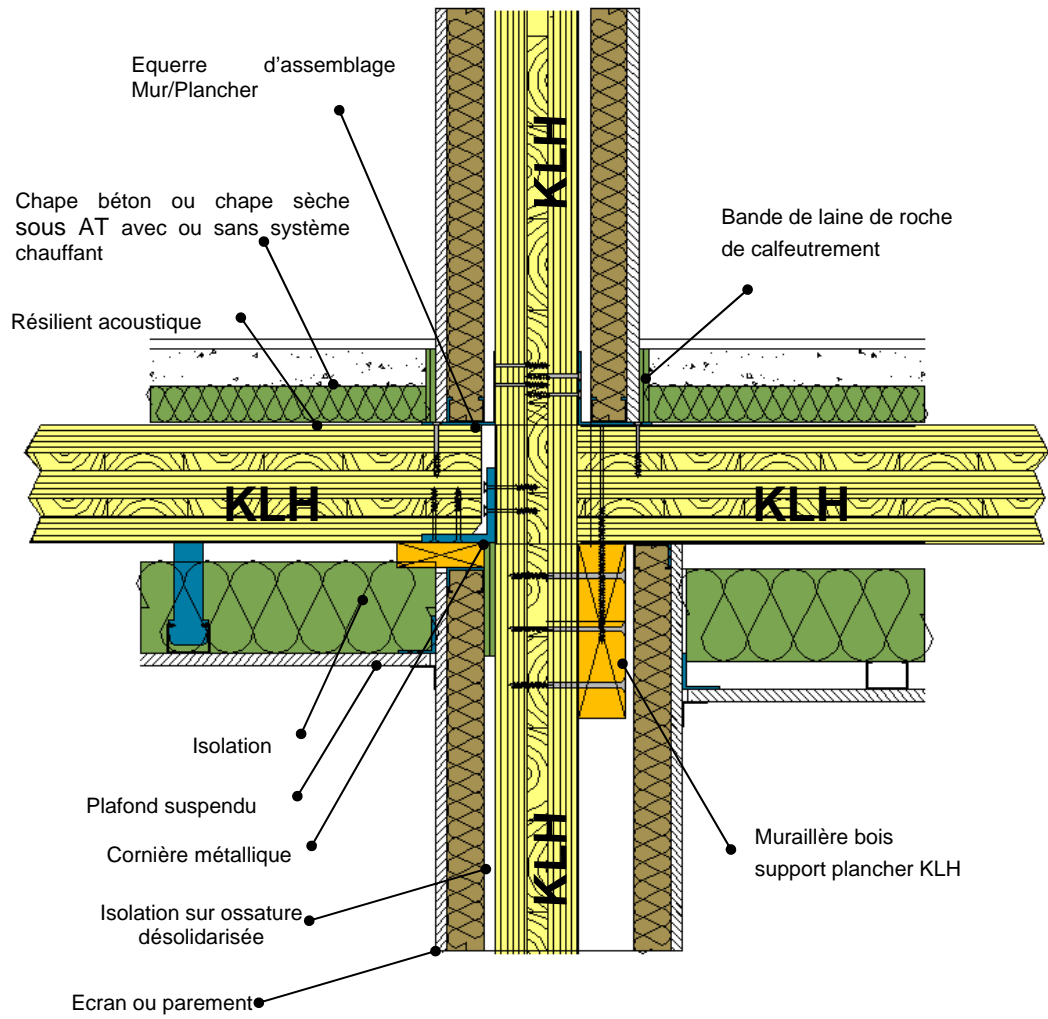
Coupe verticale sur locaux mitoyens et superposés avec plancher interrompu
